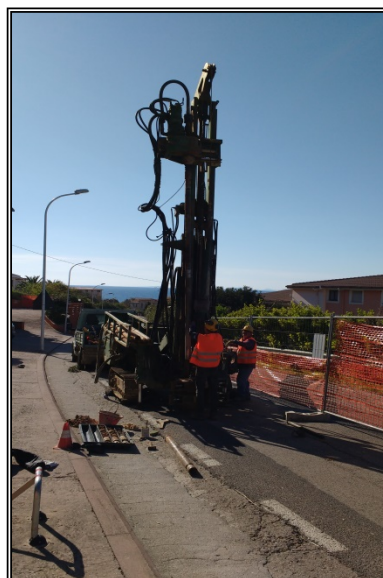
Posizionamento sondaggio n°1-2.
